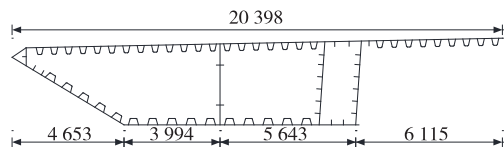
钢箱梁1/2标准截面构造示意图(单位:mm)
